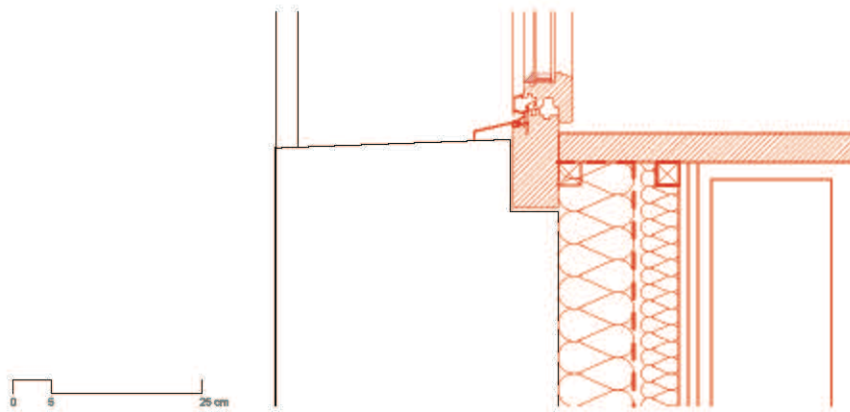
Parede tardoz de alvenaria com isolamento interior. Rue Rousseau, Genebra
